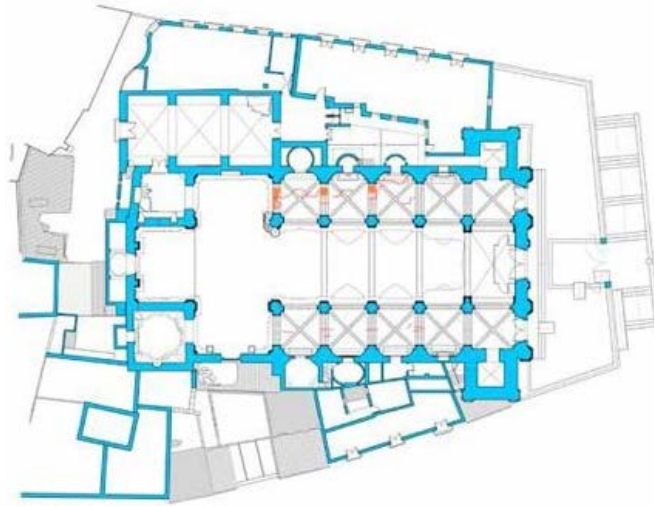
Descripción en planta de la iglesia de Santiago.
